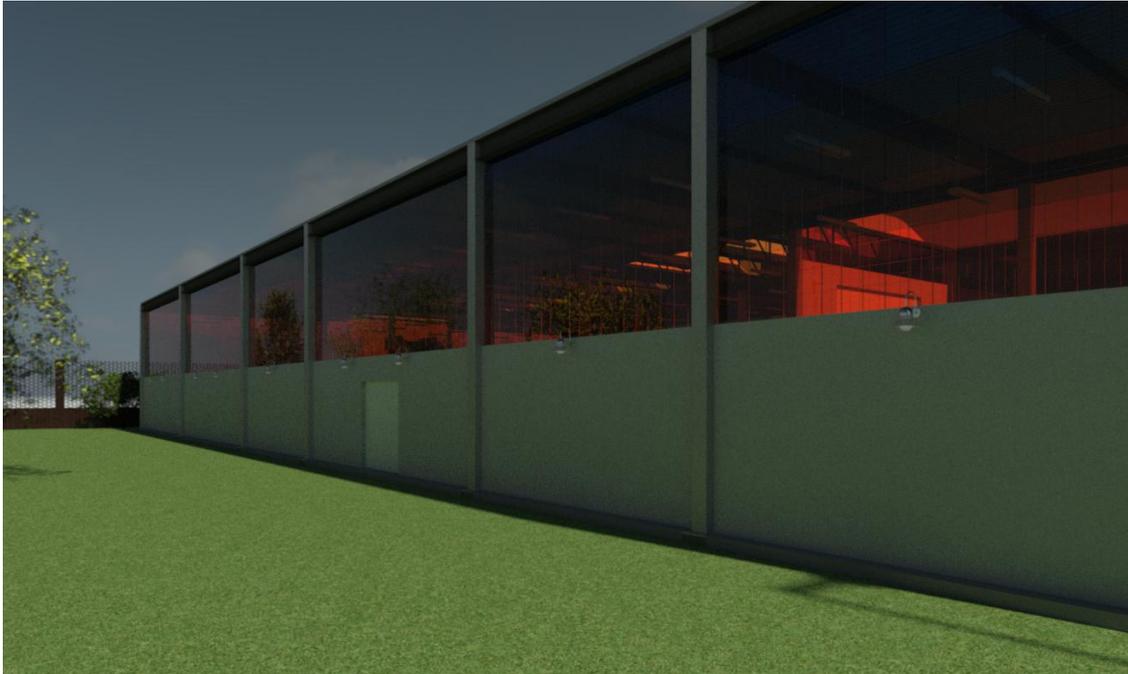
Fachada lateral nave industrial. Fuente: elaboración propia.
